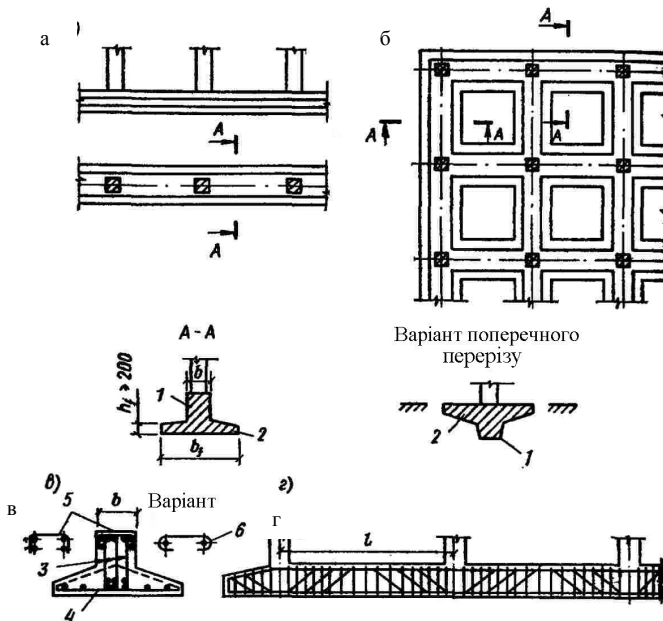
Стрічкові монолітні фундаменти під колонни:
